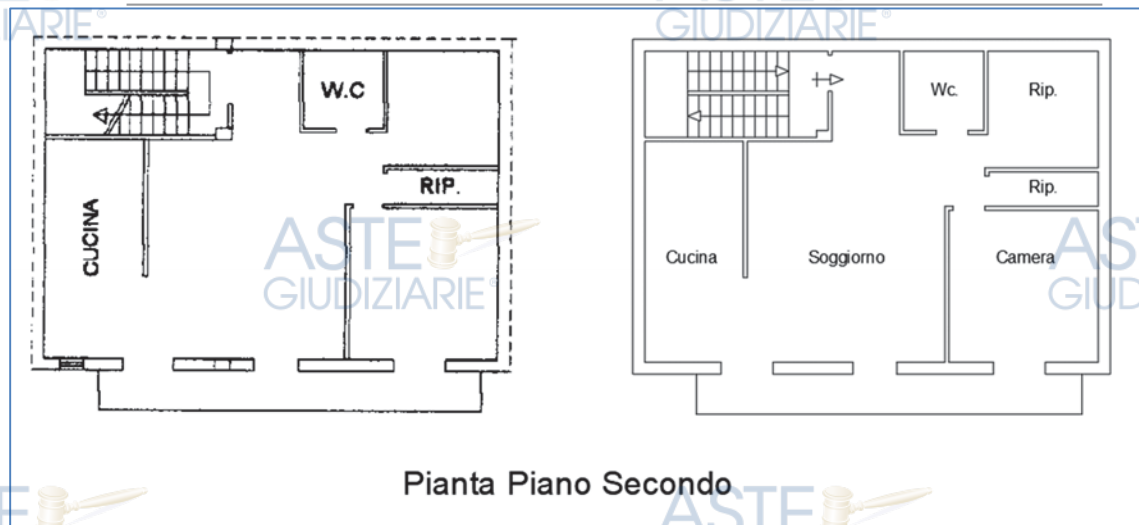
Confronto tra la restituzione grafica dello stato dei luoghi a sx e la Planimetrica catastale a dx.
